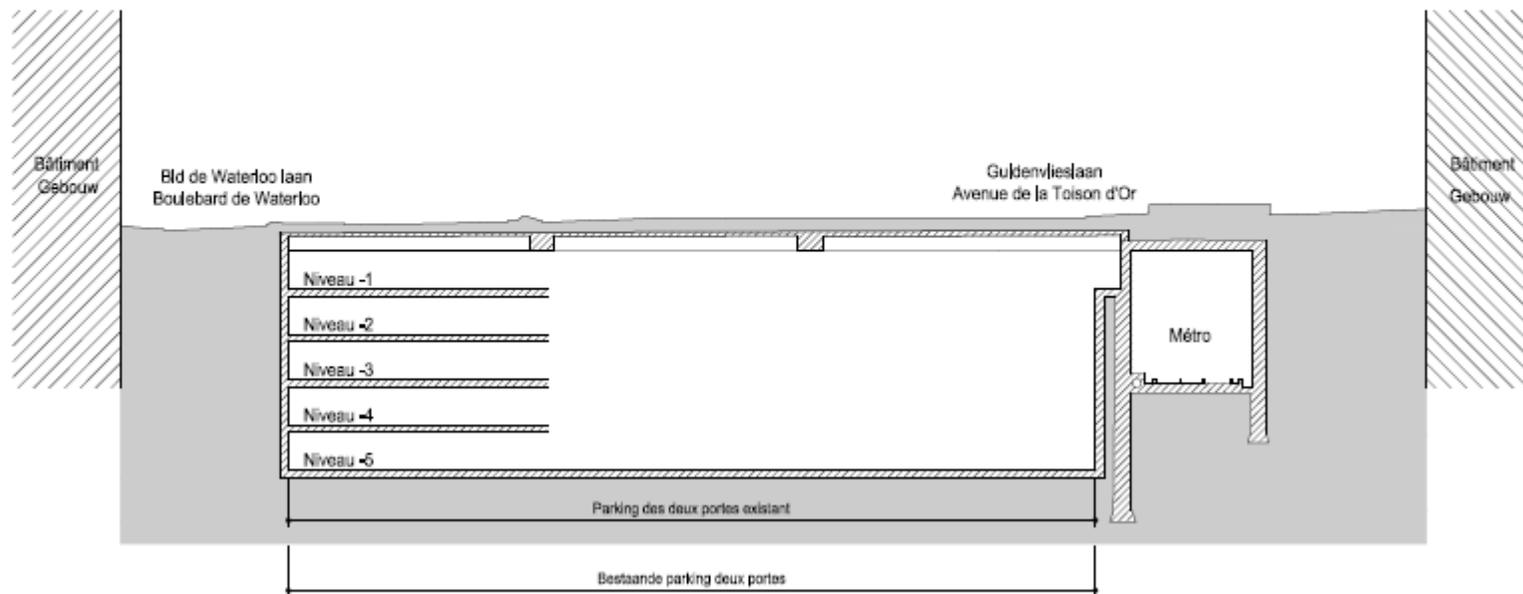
Coupe transversale 6 de la zone du projet dans la situation existante.
